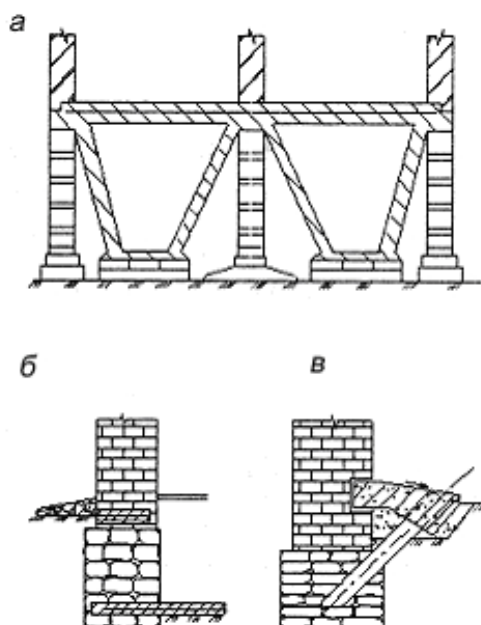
Удосконалені методи підсилення фундаментів на основі традиційних: а – конструкція з збірних або монолітних рам у підвалі; б, в – виносні консолі і плити
